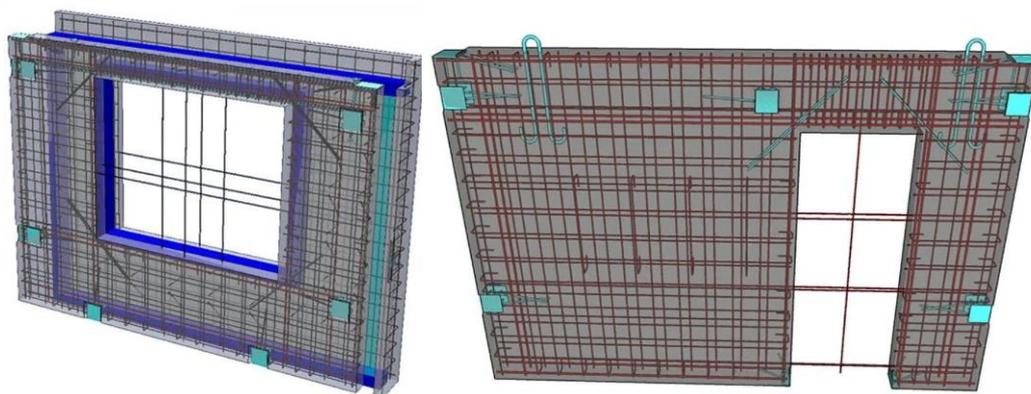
Армирование стеновой панели с помощью BIM технологии на основе Allplan Precast
